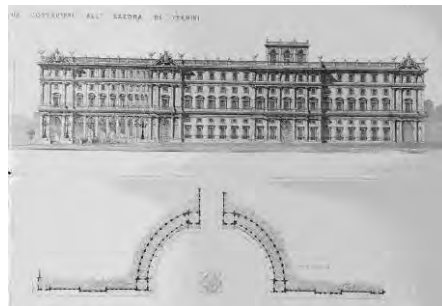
prospetti di destra su piazza Esedra e pianta dei portici versione con altana
